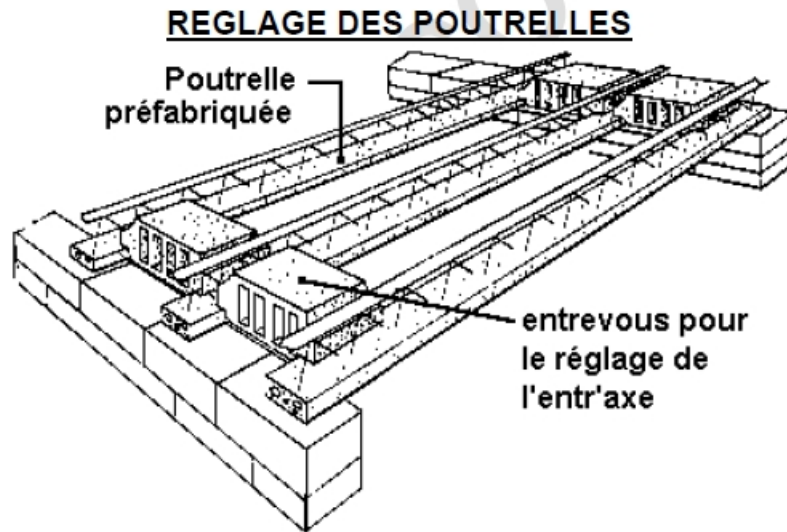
Mise en œuvre des planchers avec poutrelles préfabriquées
